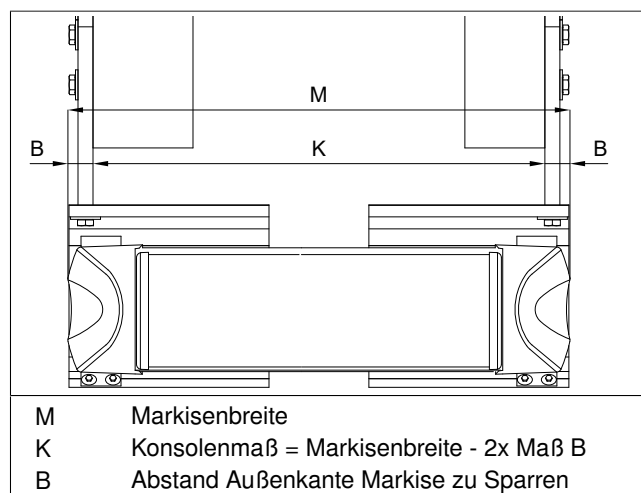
Maß-Skizze für Konsolenposition (am Beispiel Dachsparrenmontage)
